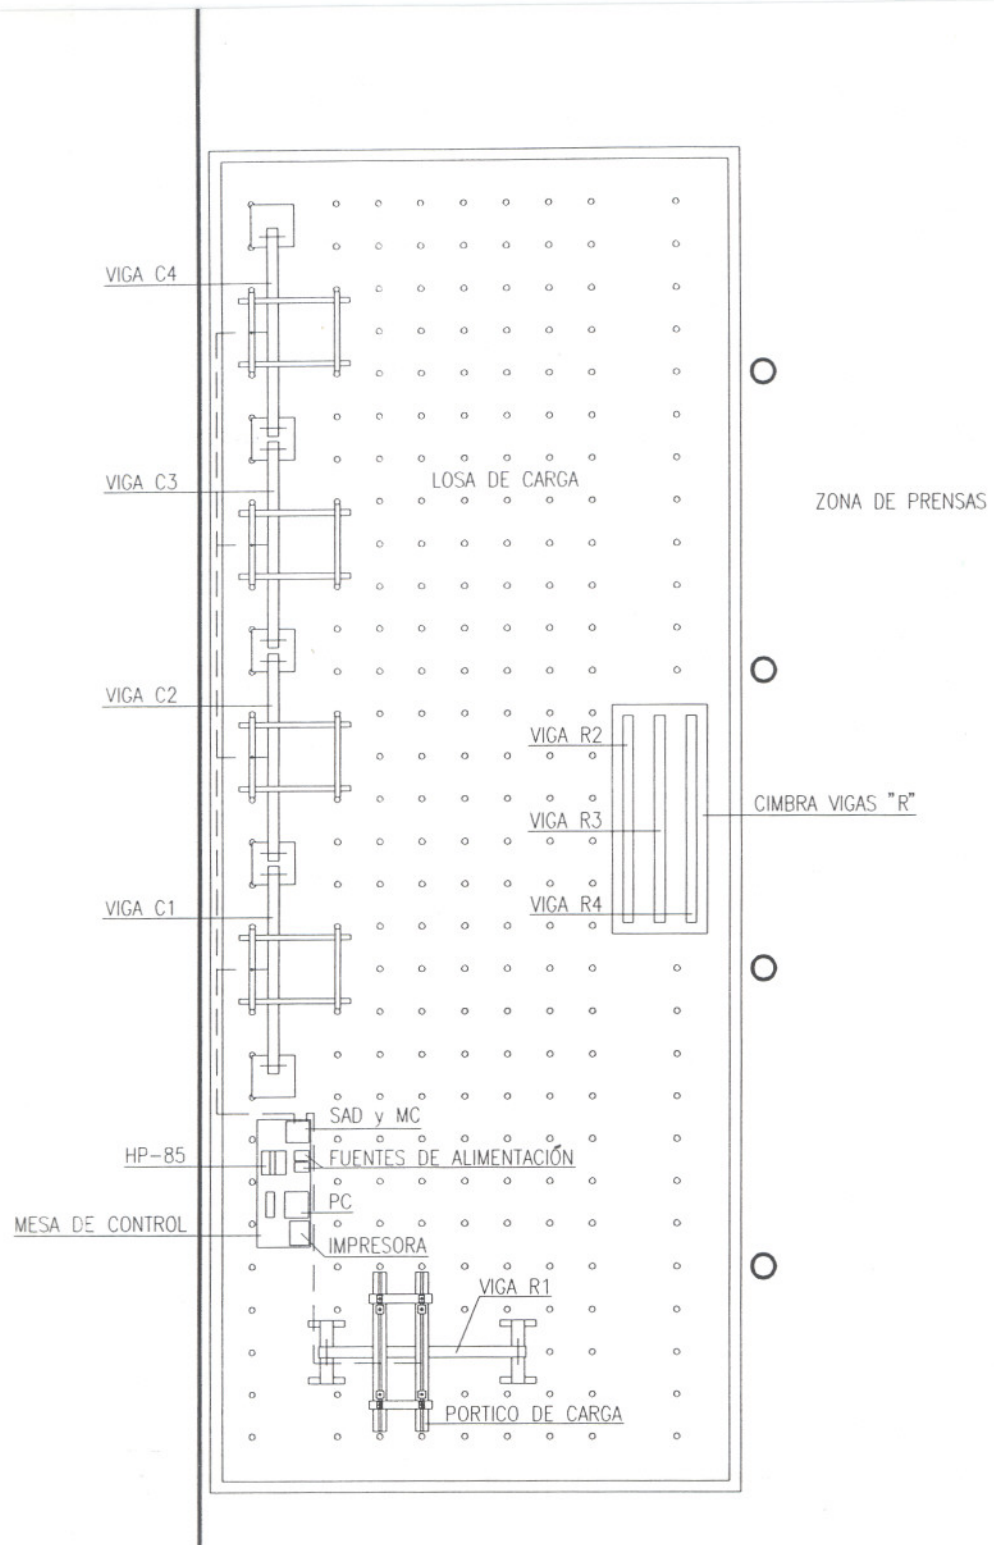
Esquema en planta de la situación de las vigas, el pórtico de carga y el centro de control, dentro del laboratorio.
